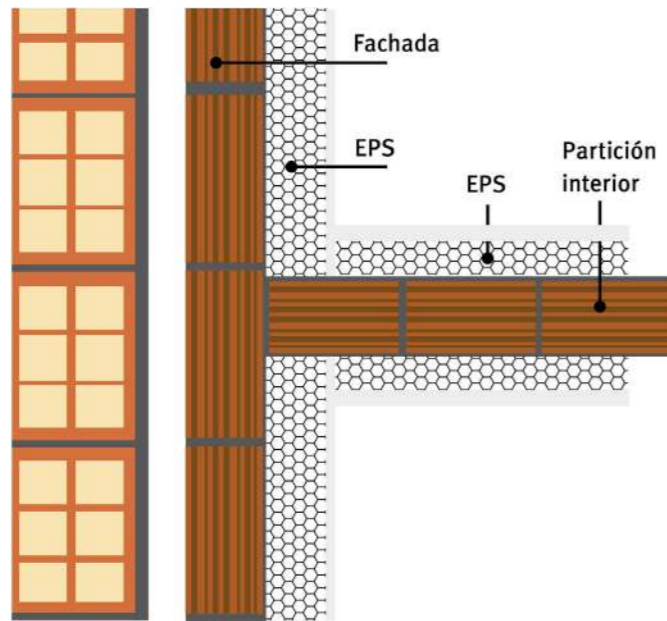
Detalle 4. Aislamiento térmico por el interior. Encuentro de fachada con particiones interiores.
